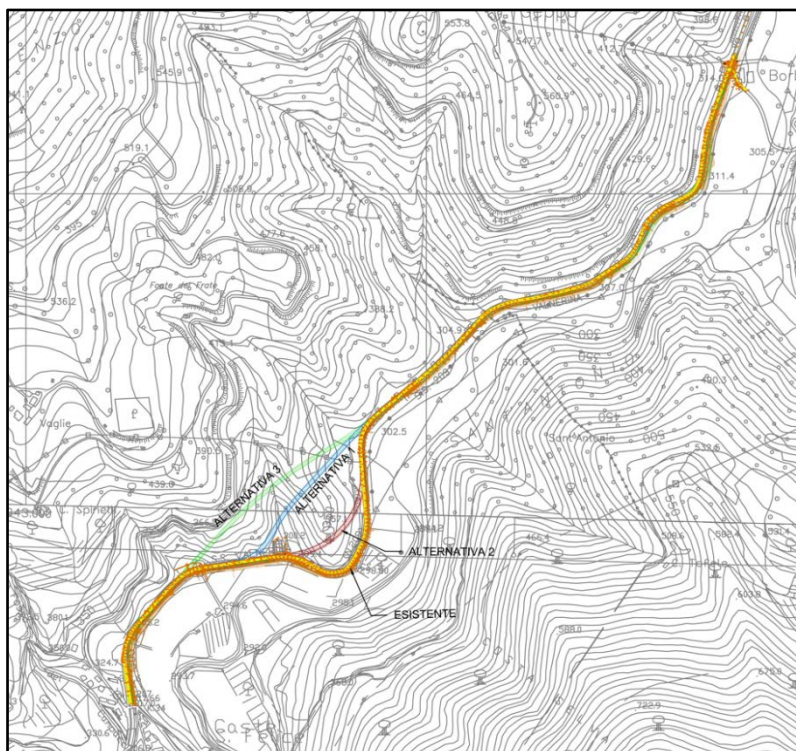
Sviluppo planimetrico dei tracciati alternativi di progetto.
